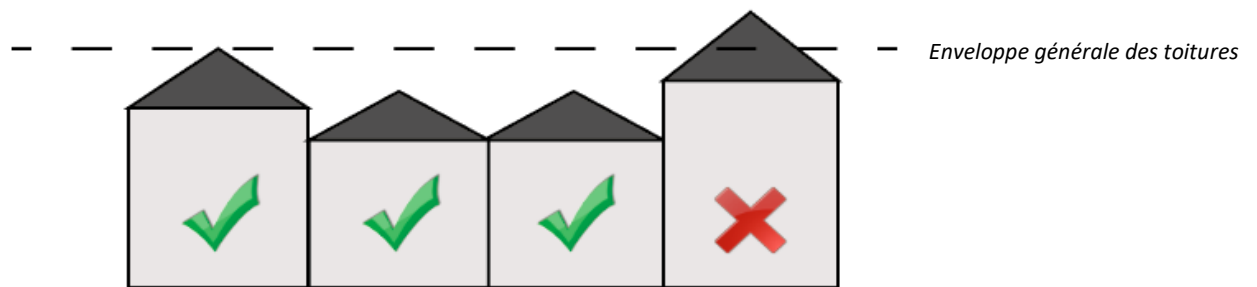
Schéma descriptif de l'implantation de constructions sous l'enveloppe générale des toitures
